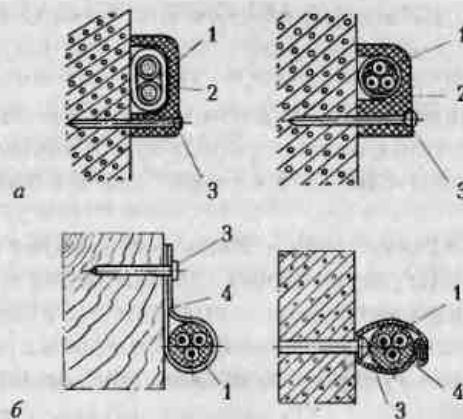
Крепление открытой проводки пластмассовой скобкой (а) и металлической лентой (б):
